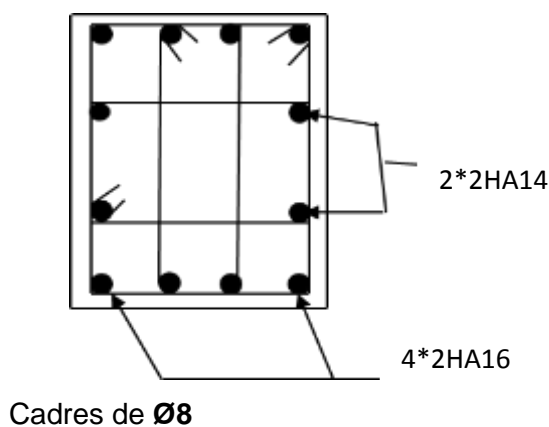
schéma de ferrailage des Poteau (55x50) cm²
